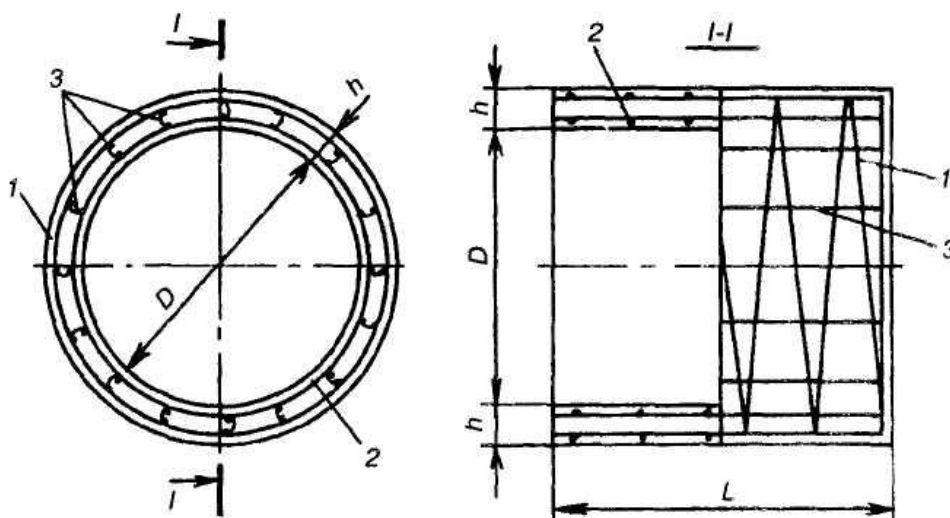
Схематичное армирование железобетонного кольца водопропускной трубы.
